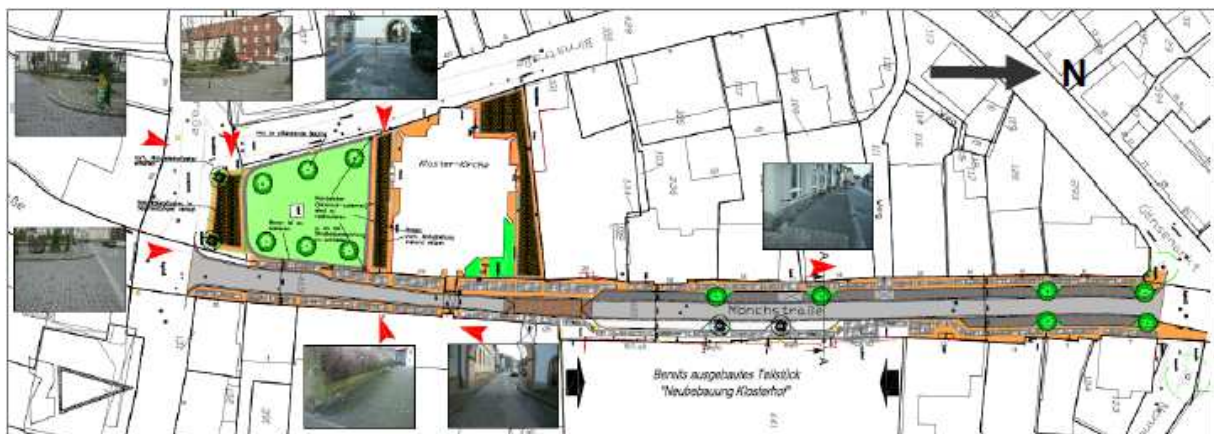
Ausbauplan Mönchstraße (eigene Darstellung)
